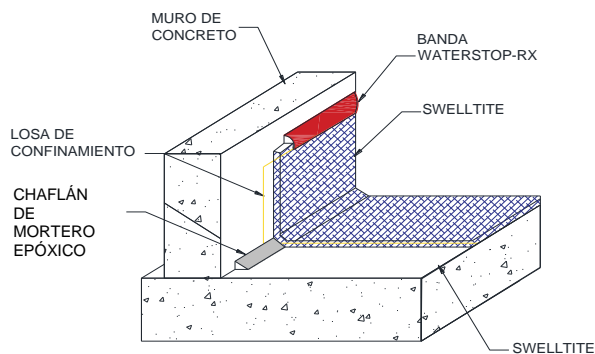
Detalle de un ángulo de transición de impermeabilización.
